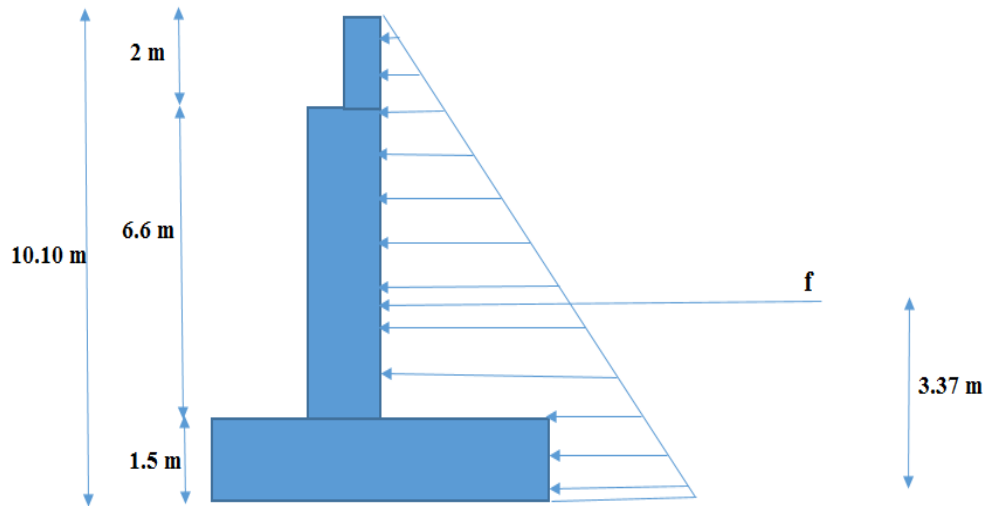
Poussée des terres sur (le mur frontal + mure garde grève et la semelle).
